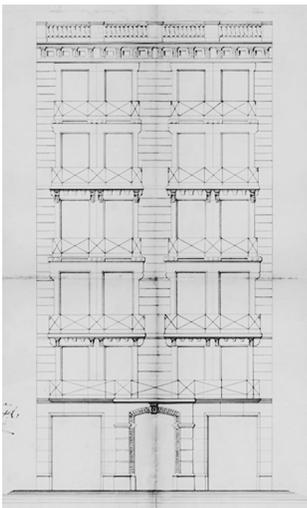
Fassadenansicht des ursprünglichen Wohnhauses mit tiefem Grundriss in Jahre 1890.
